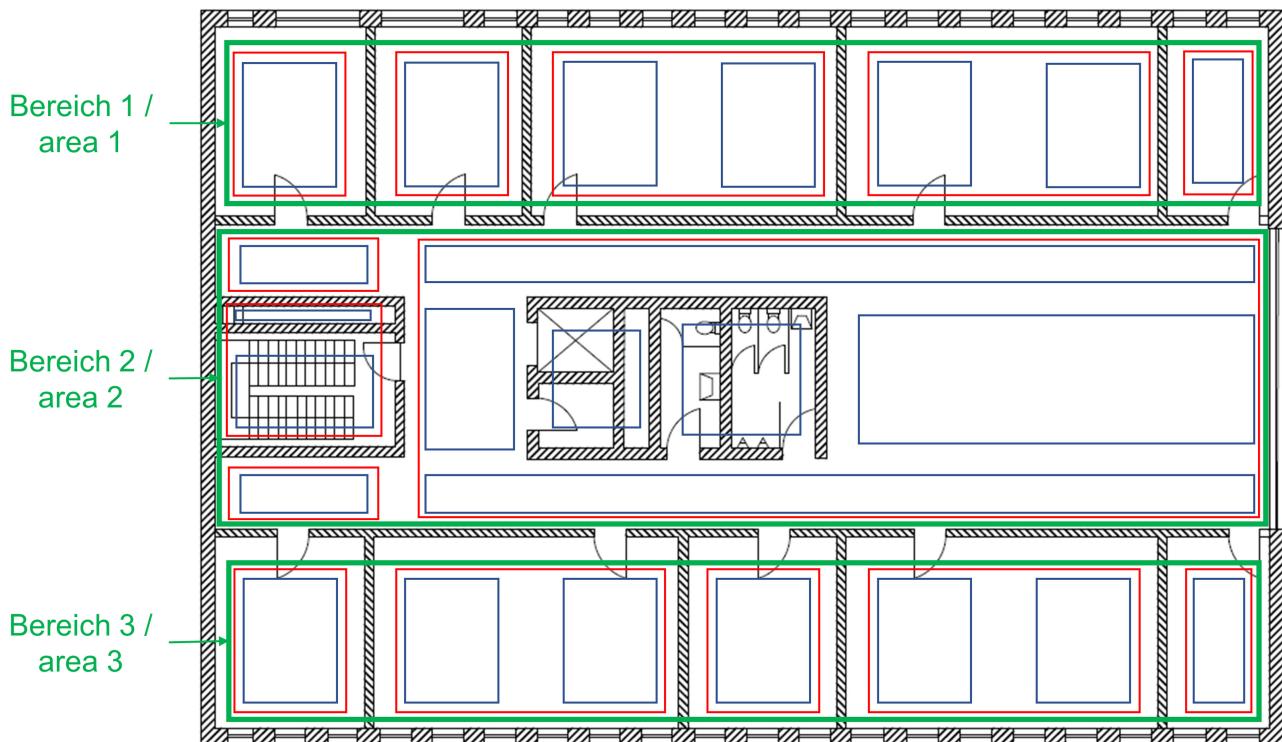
Beispiel für Zuordnung von Segmenten (S), Räumen (R) und Bereichen (B) für das Mustergebäude / Figure 9. Example for the allocation of rooms (R), segments, and areas (A) in the specimen building
